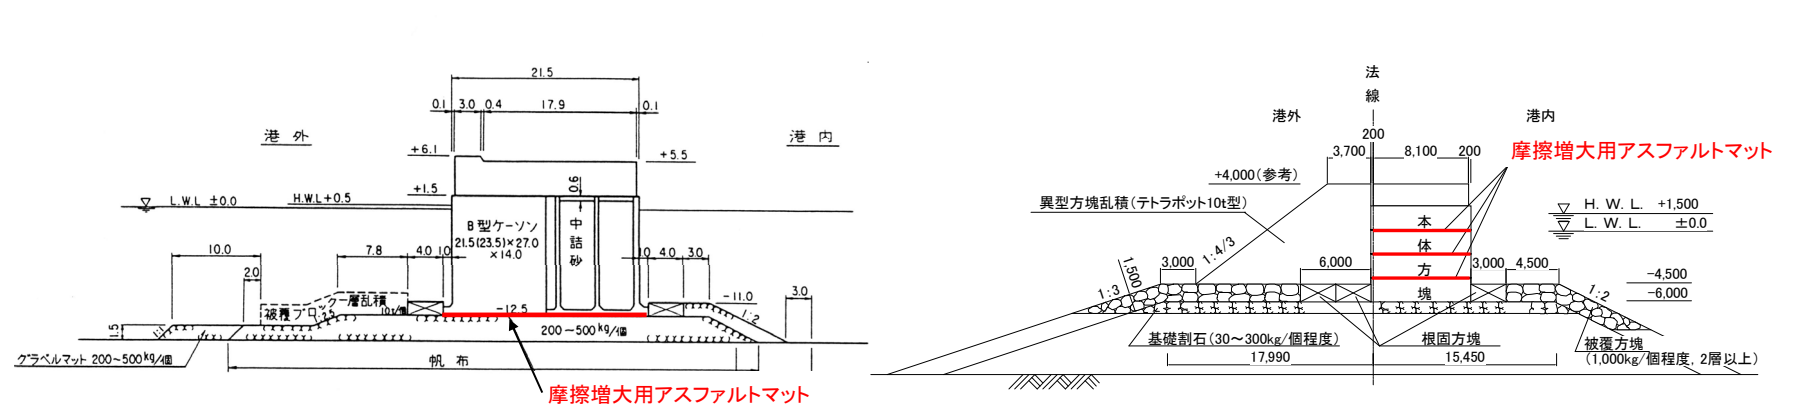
摩擦増大用アスファルトマット適用断面図(施工例)
